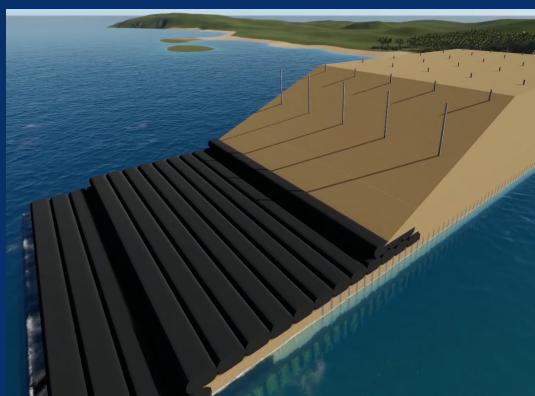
Hasil Uji Lapangan Timbunan untuk Platform Lantai Kerja pada Lapis Kedua
